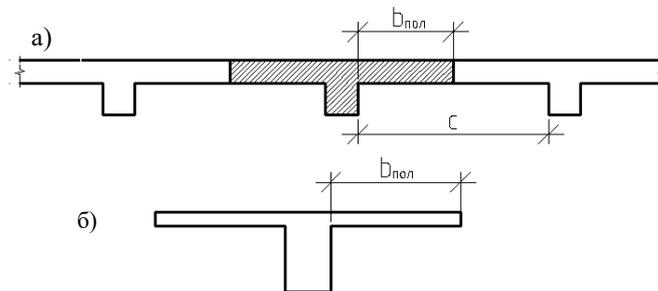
Участки свесов тавровых сечений, вводимые в расчеты:
